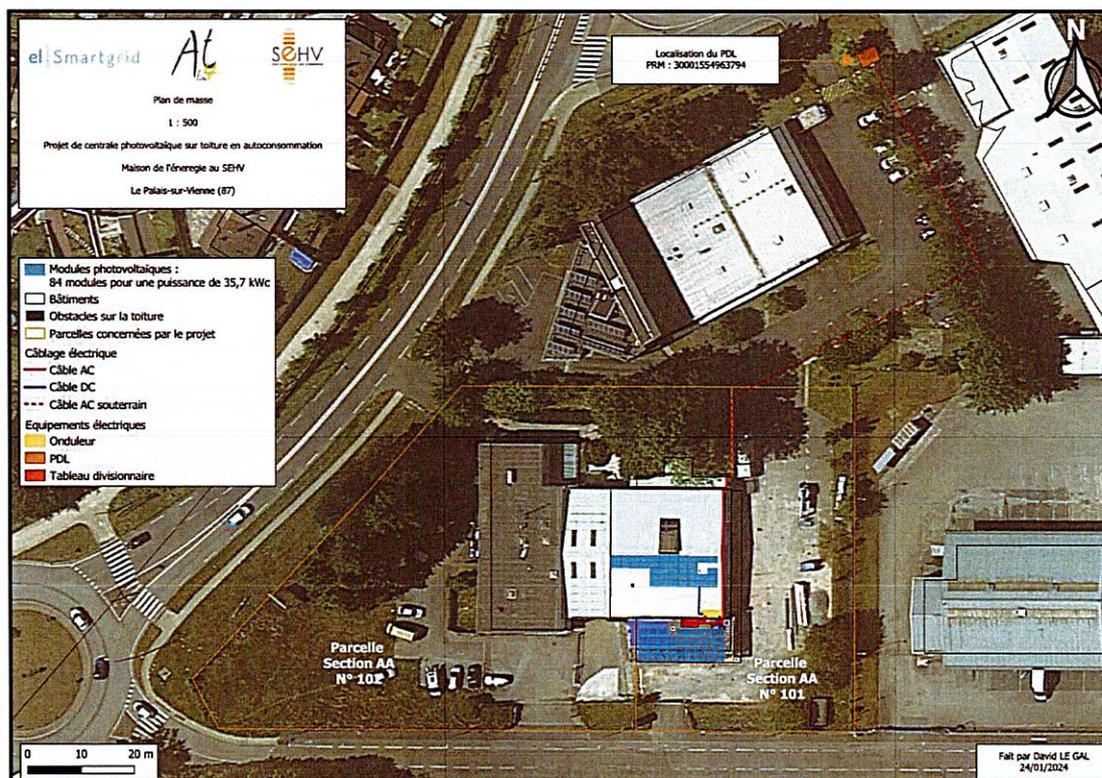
Plan de calepinage de la central photovoltaïque 35,7 kWc
